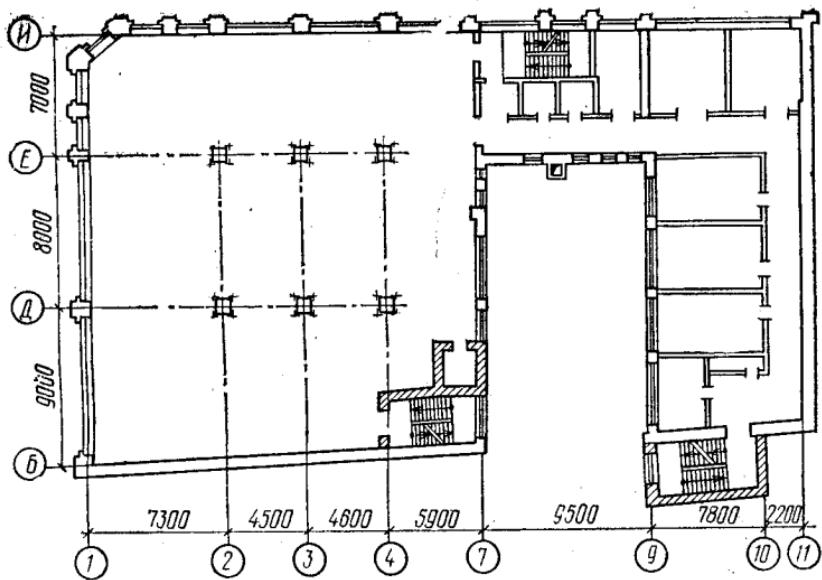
План типового этажа реконструированного здания Харьковского художественно-производственного комбината
